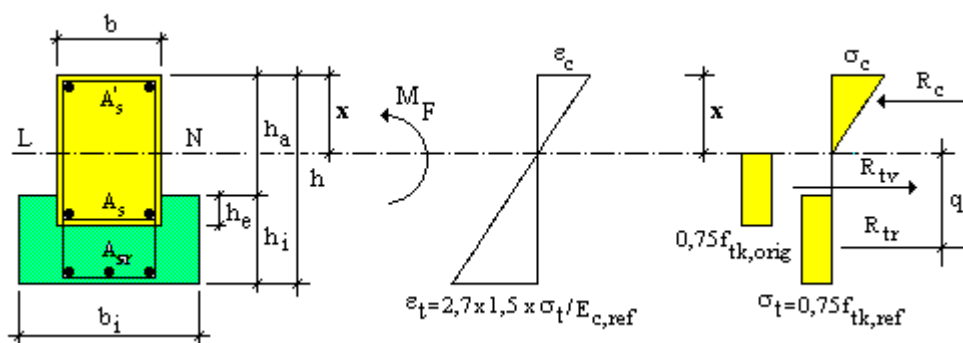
Seção Transversal Real - Estados de Deformação e Tensão - Fissuração pela NBR-6118 - Vigas das Séries 2 e 3
